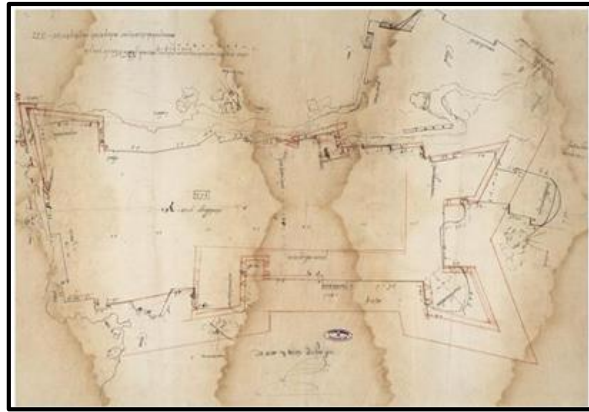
Projet dessiné pour la ville Bugia (Bejaia), plan de la muraille de la casbah, 1543 (Source : Archive général de Simancas, Espagne).
